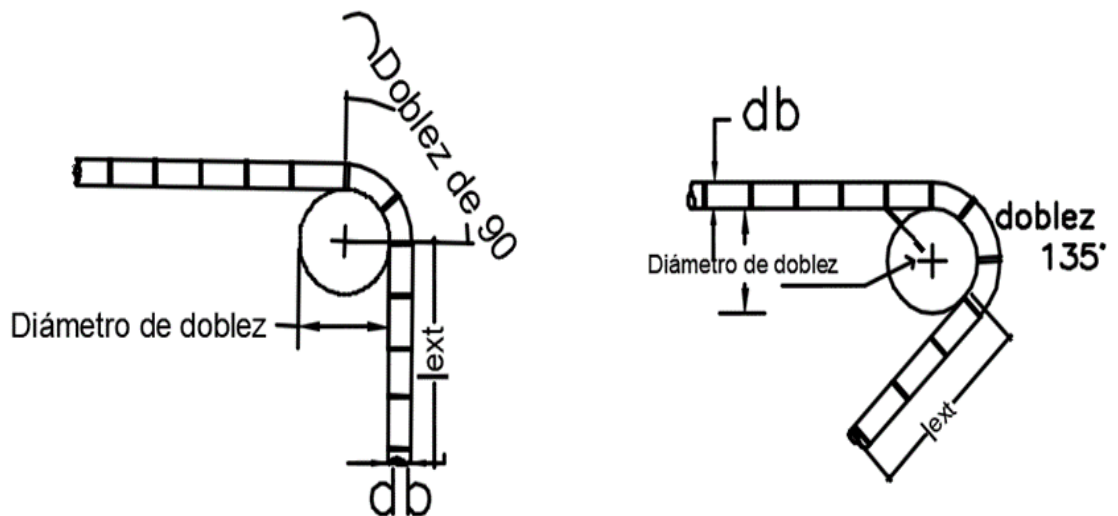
94 Gancho estándar a 90° y 135° del acero transversal. Basado del ACI 318-14.
